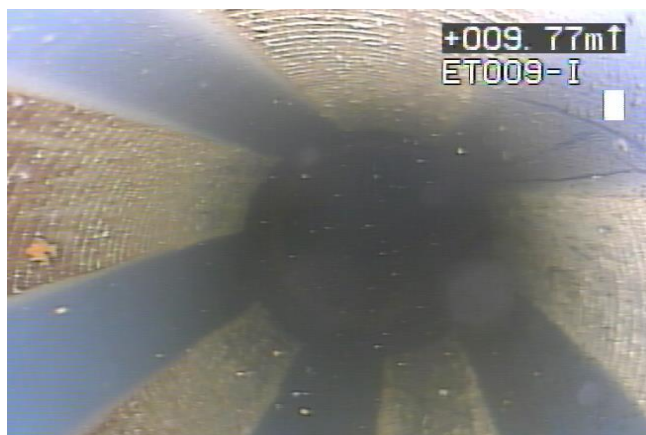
Kamerabefahrung der Filterstrecke einer Grundwassermessstelle
